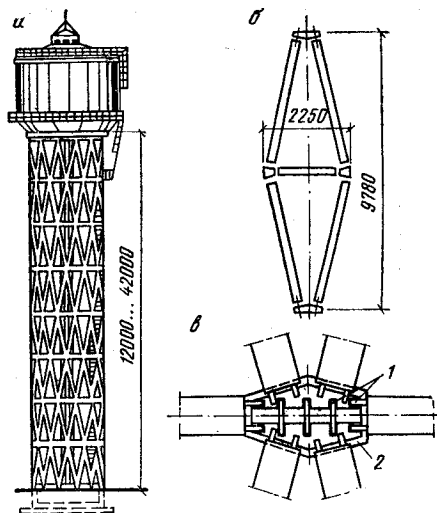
Водонапорная башня со сборной железобетонной сквозной сетчатой опорой
